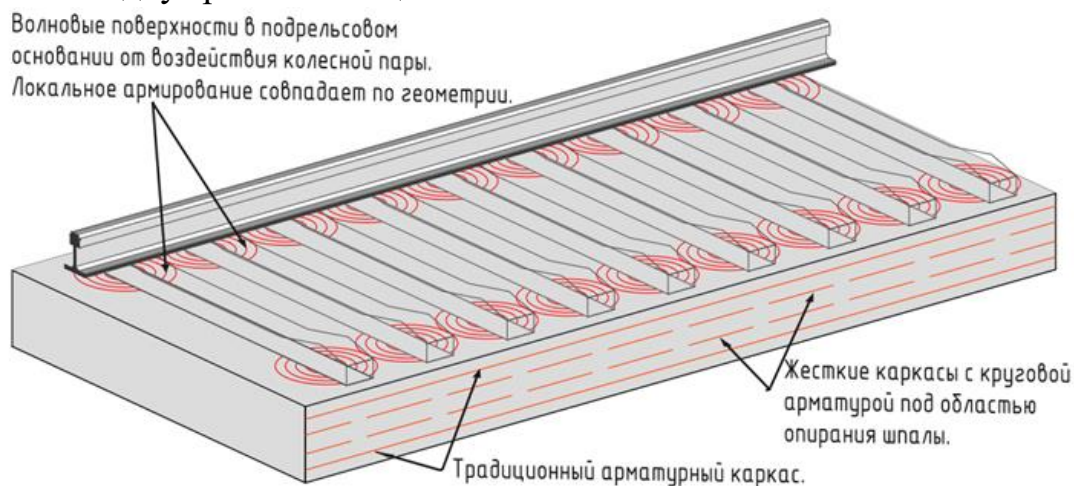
Модель ж/д. пути с предлагаемой схемой армирования
